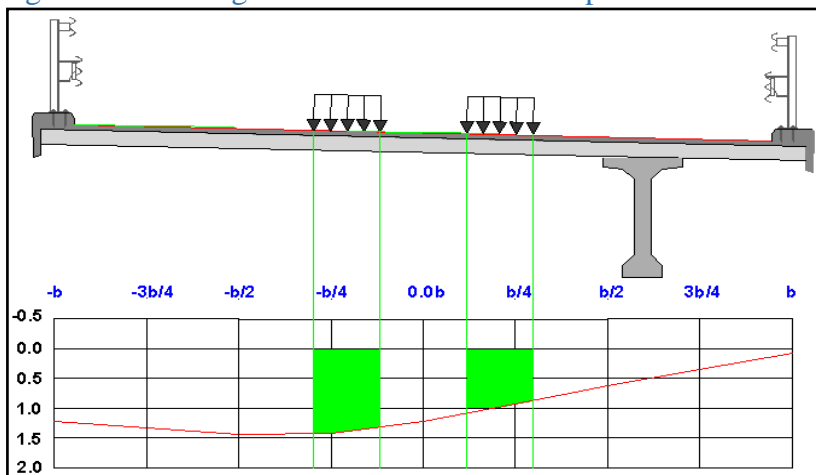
Chargement Mc120 sur Li de la poutre 3
